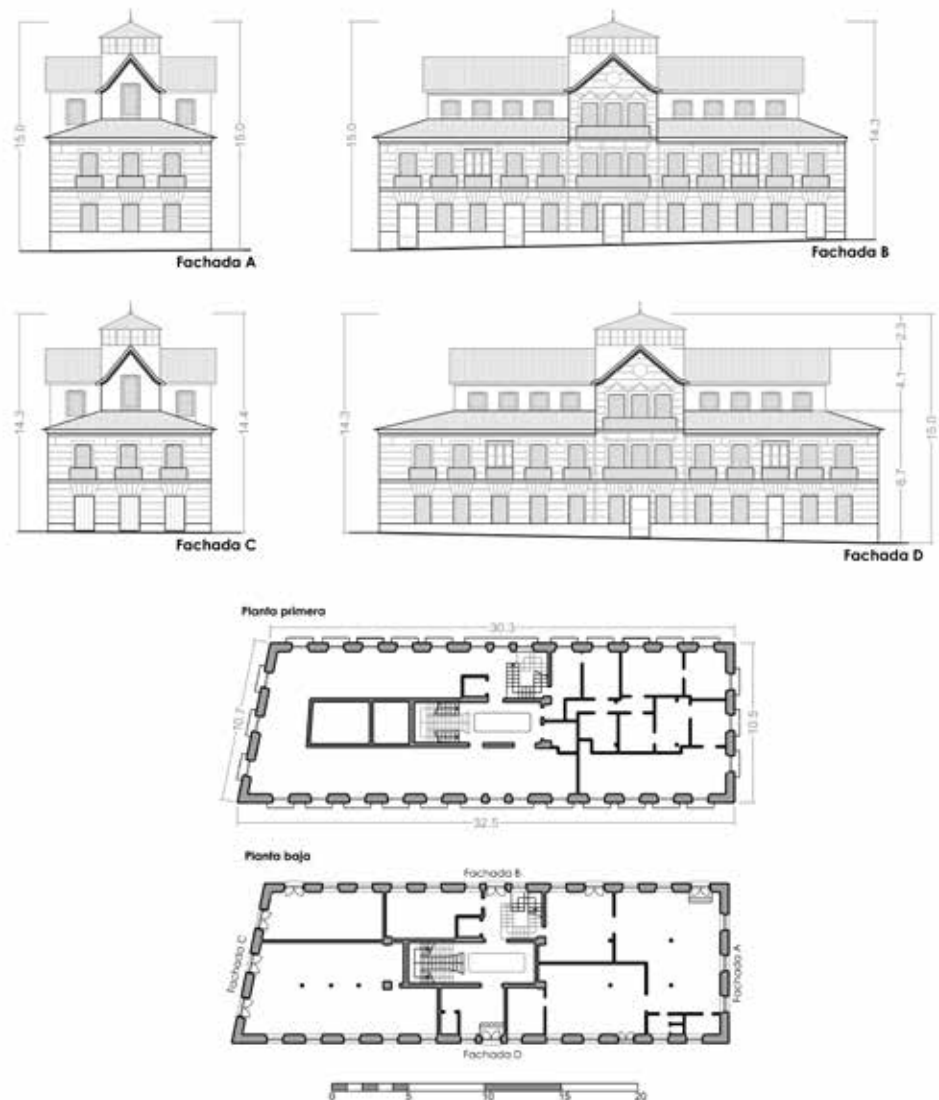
Plantas baja y primera y alzados de la Casa Rubio. Fuentes: Exmo. Ayuntamiento de Cartagena y elaboración propia.
